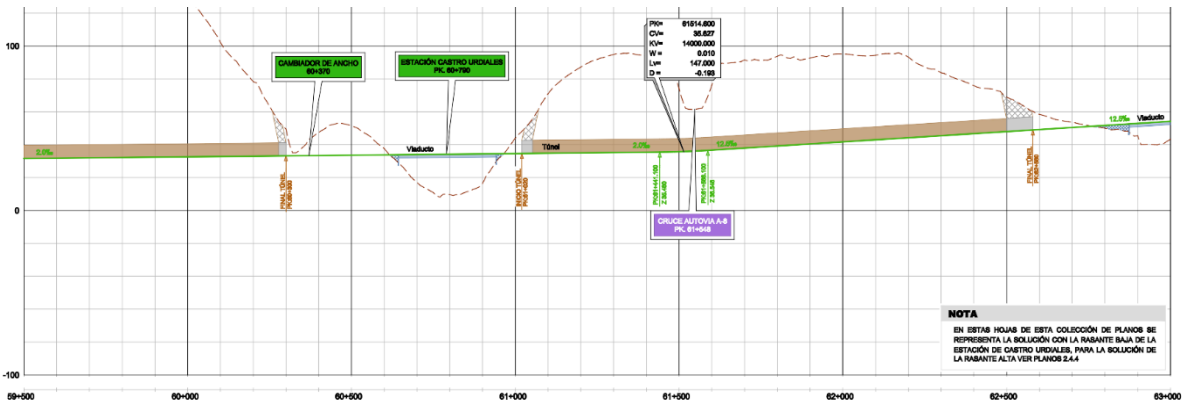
Perfil longitudinal Alternativa C1 rasante baja. Estación Castro-Urdiales
